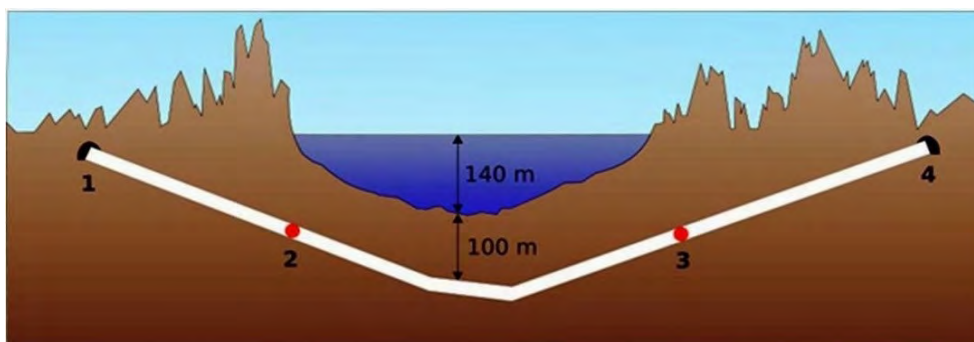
Tunnel Seikan – Profilo longitudinale<sup>188</sup>
